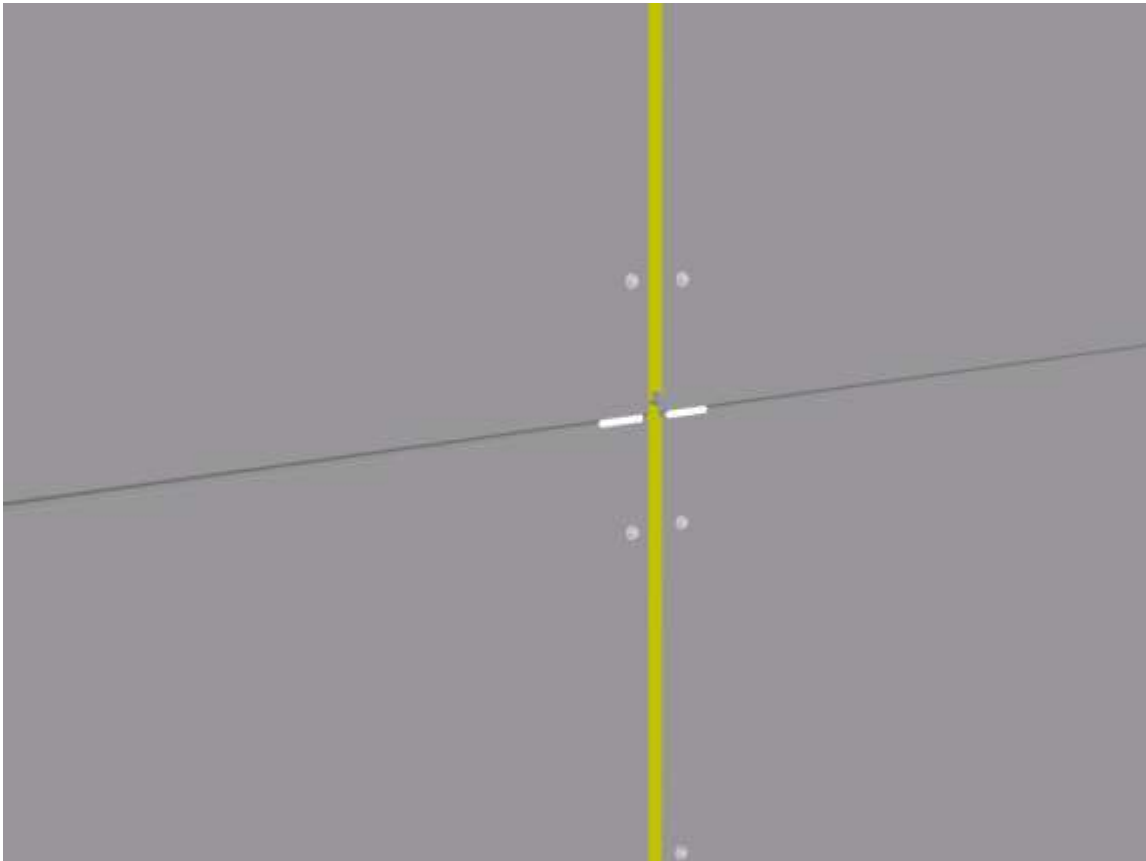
ter – Croisement avec les compléments d'étanchéité verticaux
